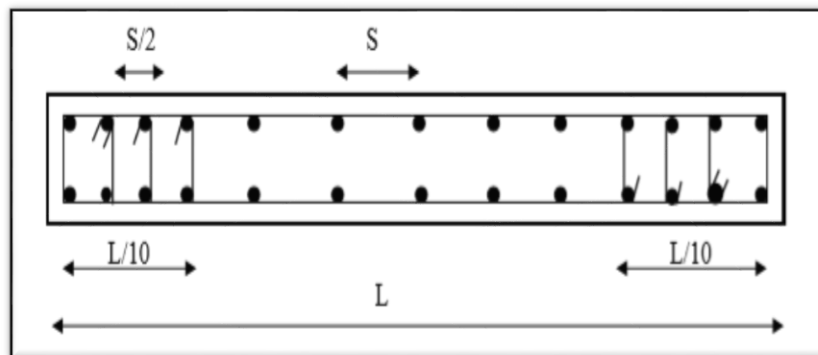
Disposition des armatures verticales (vue en plan)
